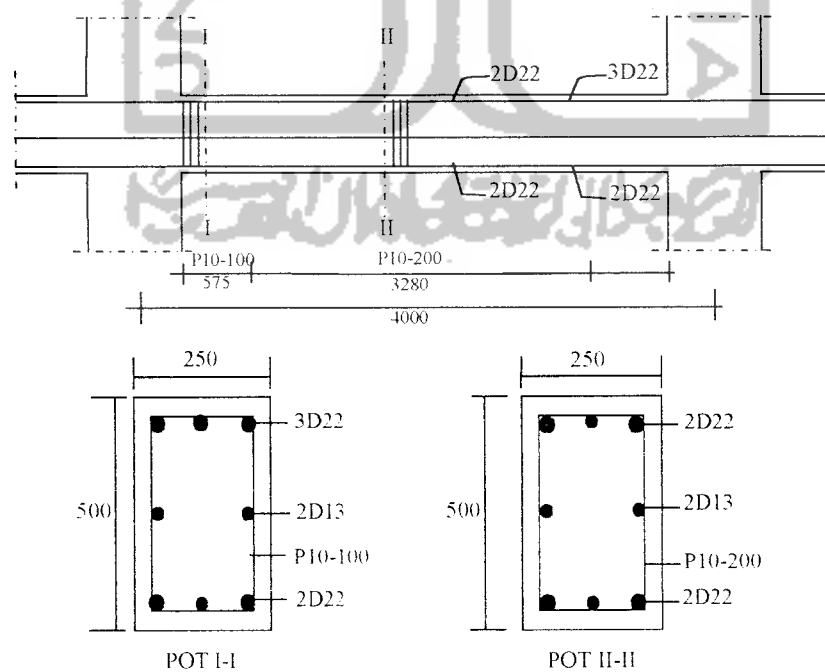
Balok Portal E Bentang 4 m Lantai 10
